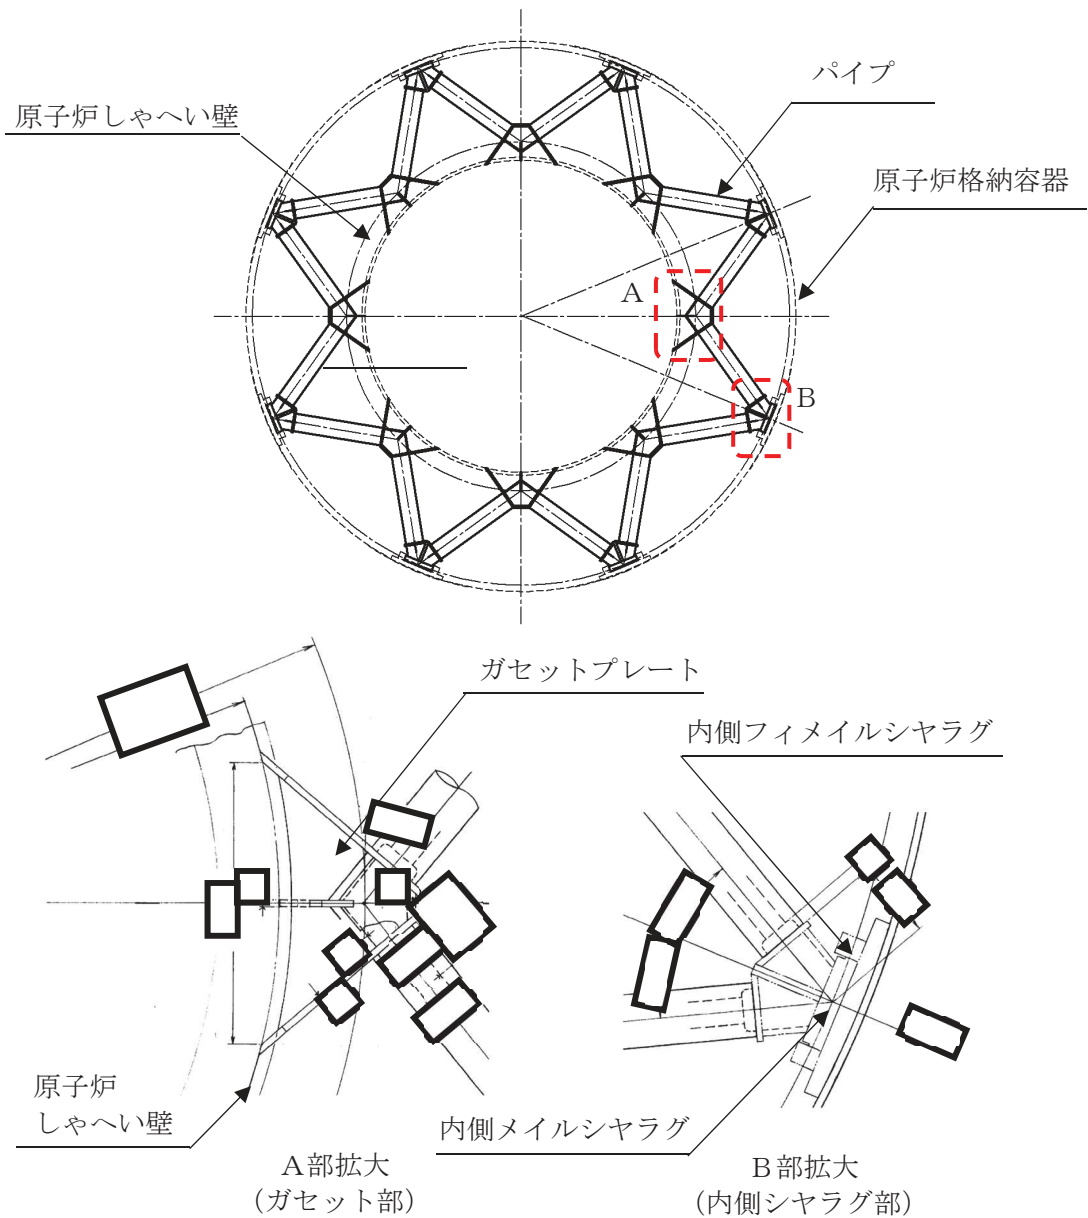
原子炉格納容器スタビライザの構造概要（平面図）
